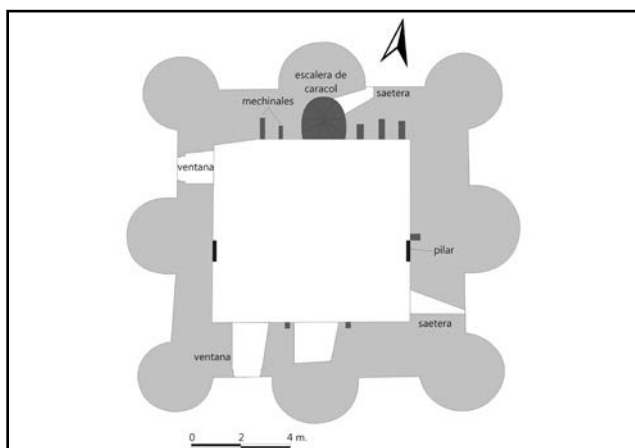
Hipótesis de reconstrucción de la planta tercera de la torre del homenaje.
